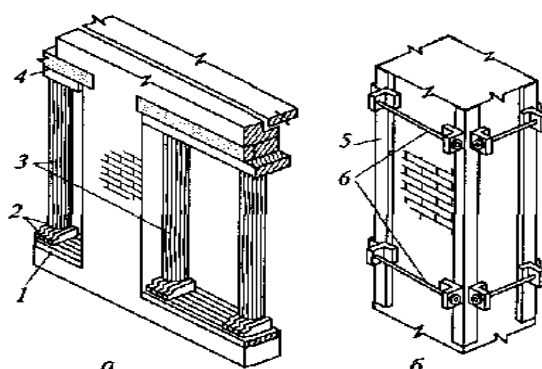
Усиление каменной кладки в период ее оттаивания: а - разгрузочными стойками; б— инвентарными металлическими хомутами; 1 — доска; 2 — клинья; 3 — стойки; 4 — подкладки; 5 — уголок; 6 — стяжка болтовая.
